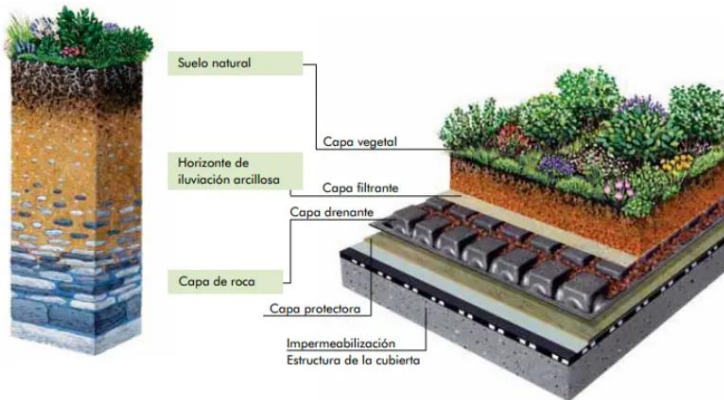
Detalle cubierta ajardinada. www.ovacen.com
